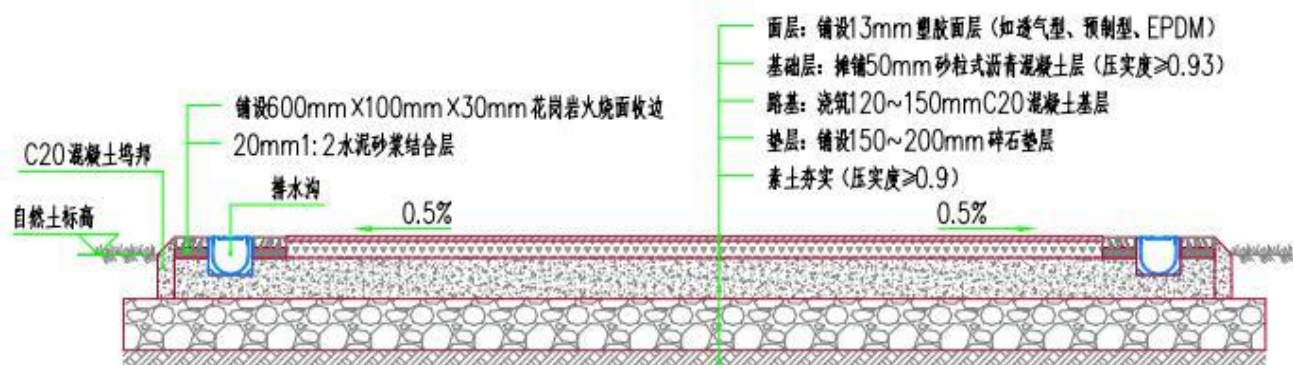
彩色沥青混凝土健身步道参考平面图 (单向标准段)
